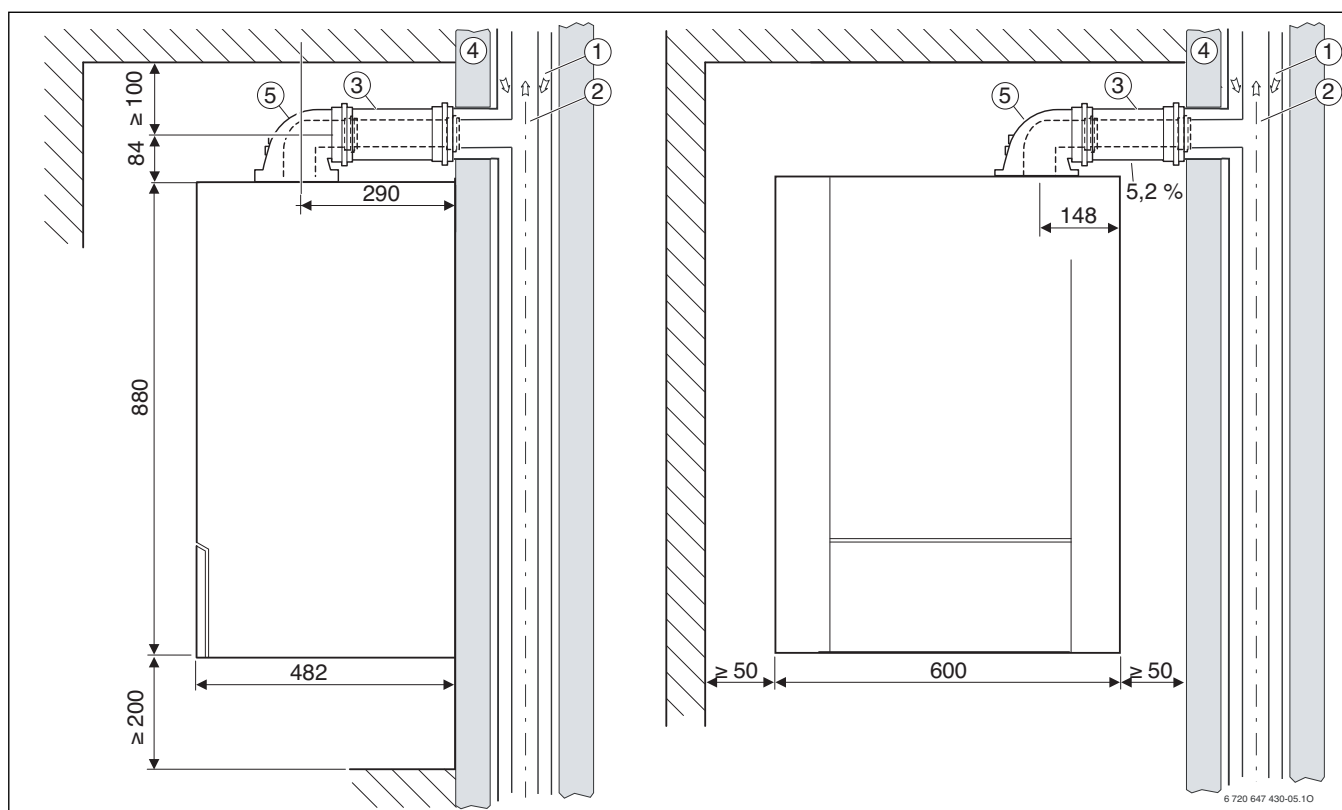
Conduits concentriques horizontaux 3CE type C₄₃
